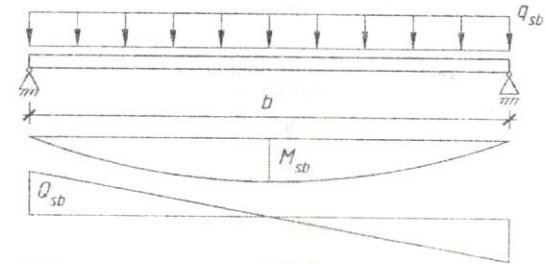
Расчетная схема второстепенной балки с эпюрами изгибающих моментов и поперечных сил
